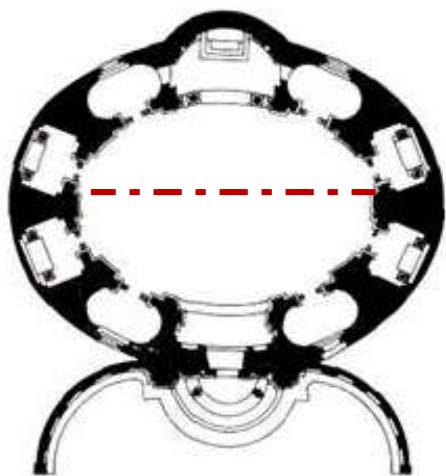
Gian Lorenzo Bernini, Pianta di Sant'Andrea al Quirinale, 1658-70
